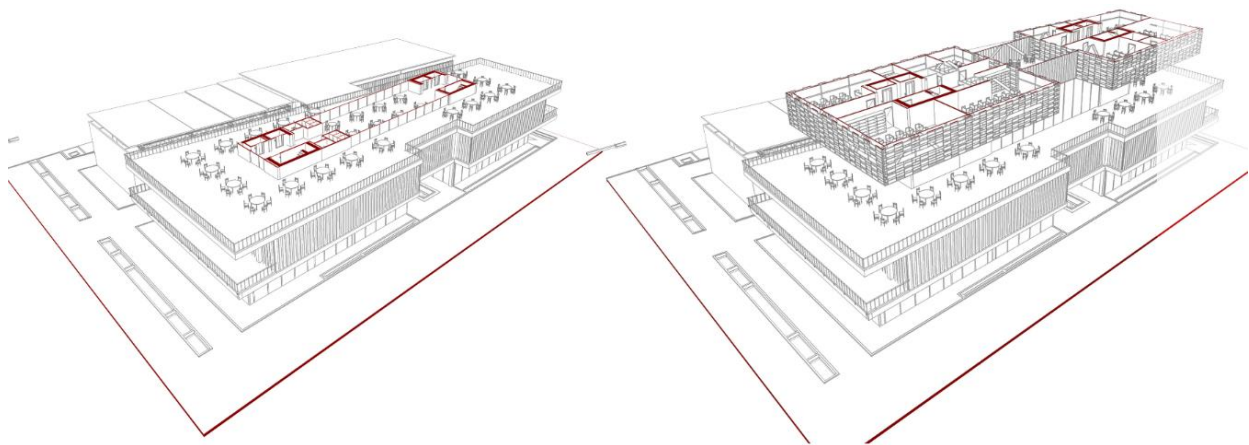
Axonometrías Arquitectónicas- Planta de Equipamiento Educativo y Espacio Público
